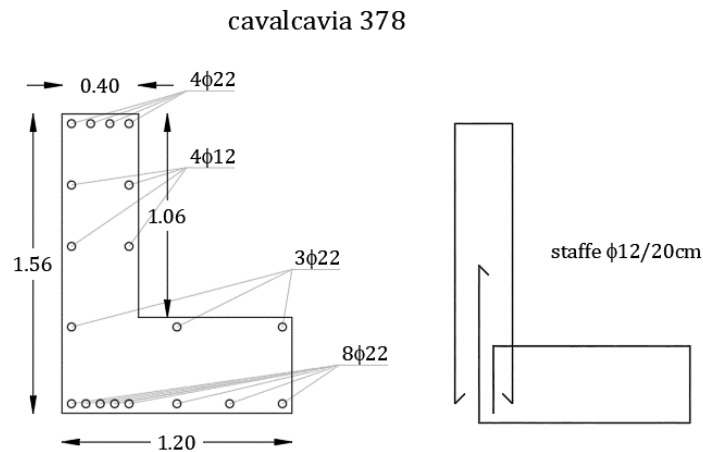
Sezione dell'architrave delle pile e disposizione dell'armatura (piano x-z)
